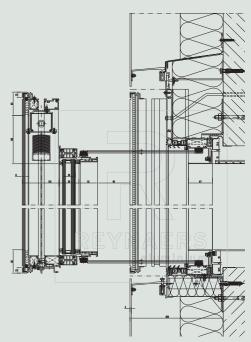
Vertikal-Schnitt Parallel-Ausstellfenster geöffnet
